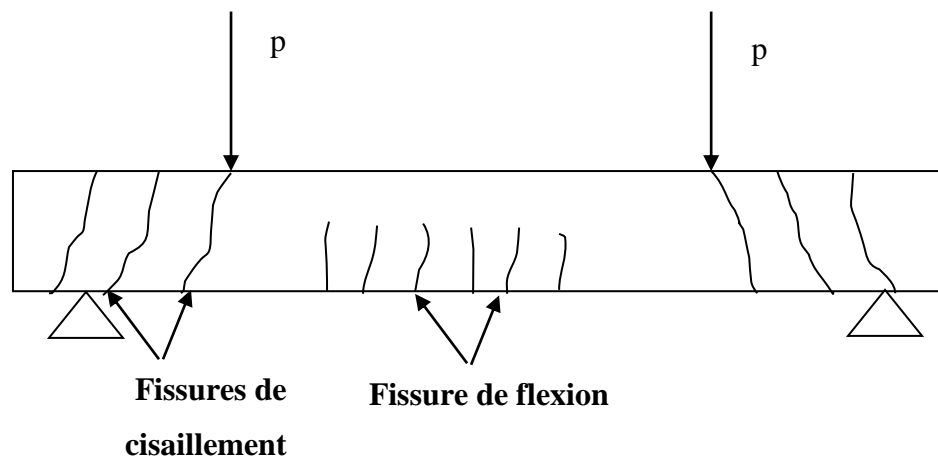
schématisation d'une poutre fissurée soumise à deux charges concentrées p
